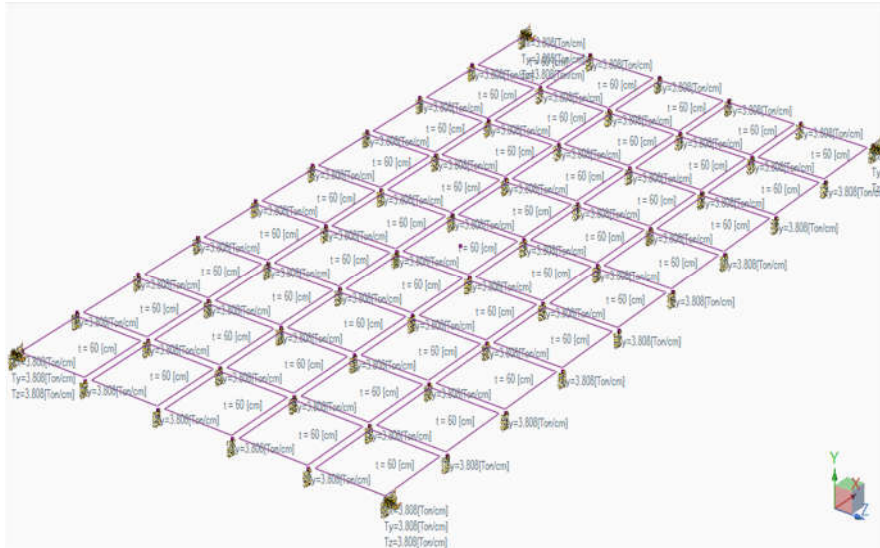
Losa de Fundación Idealizada en Ram Element
